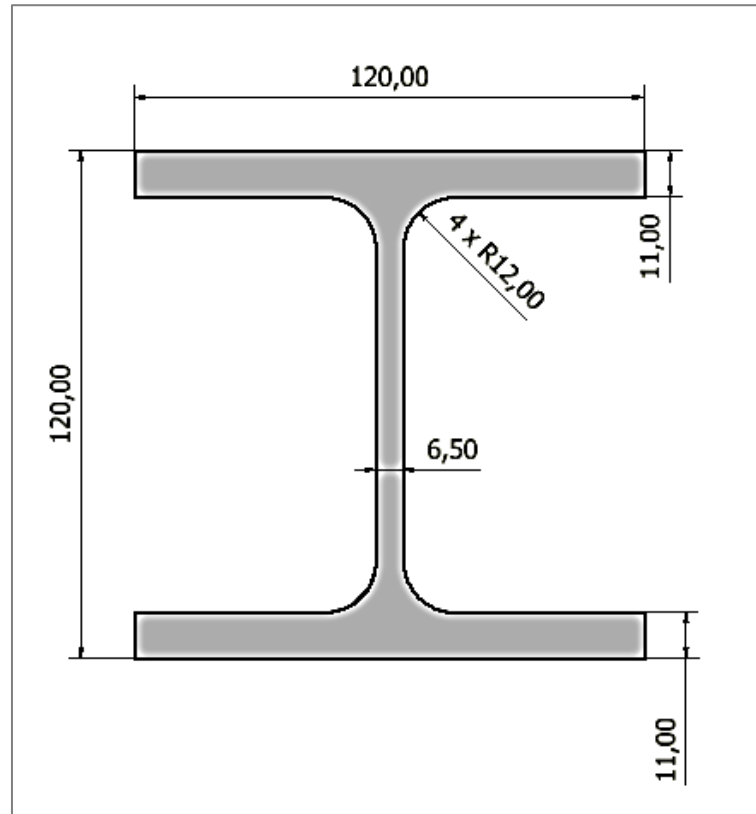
1: Sección transversal de la columna. (Elaboración propia, 2 017)
